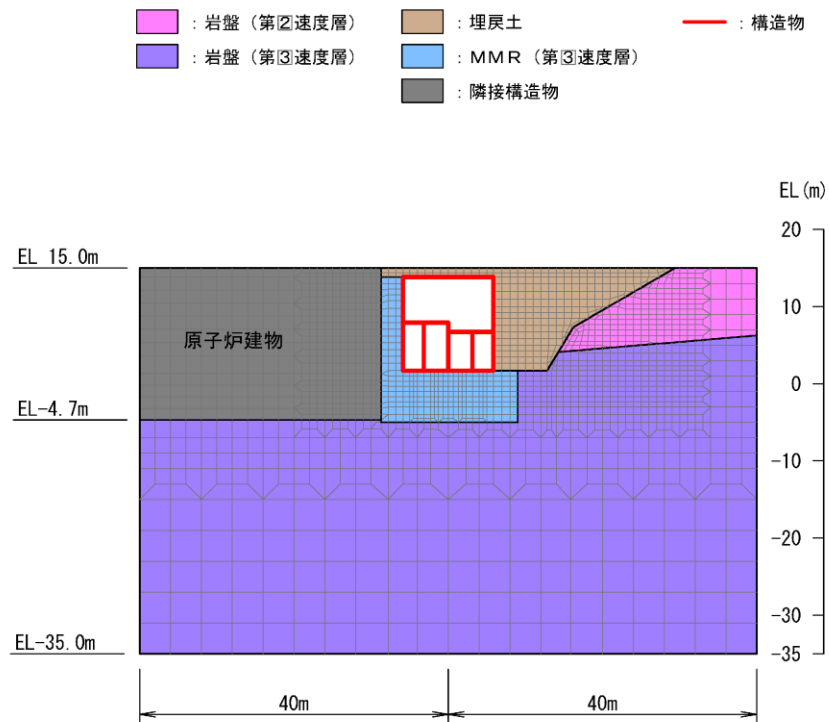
第 1 ベントフィルタ格納槽 地震応答解析モデル図 (B-B 断面)
